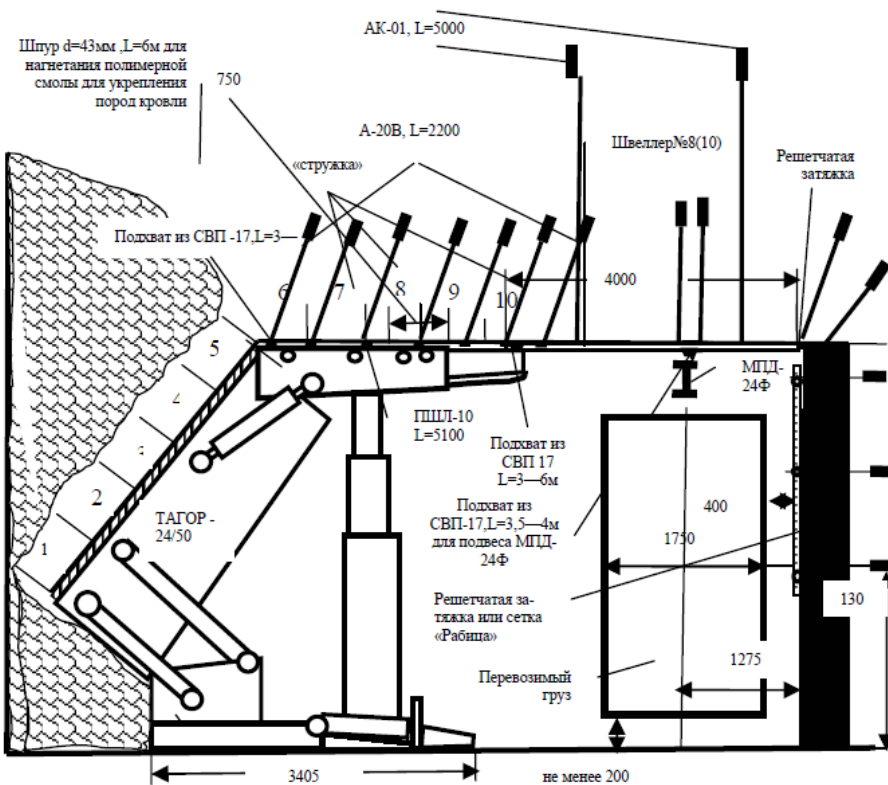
Схема подготовки демонтажной камеры №1325 [9].
